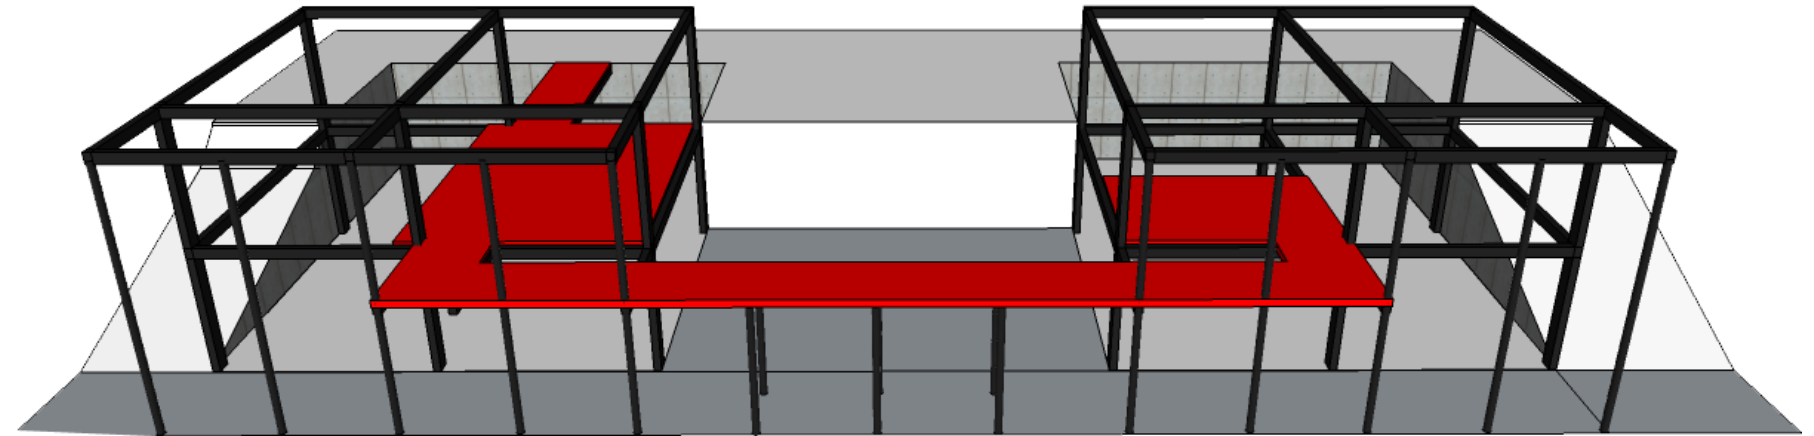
Esquema de armado estructura en biblioteca y mediateca
